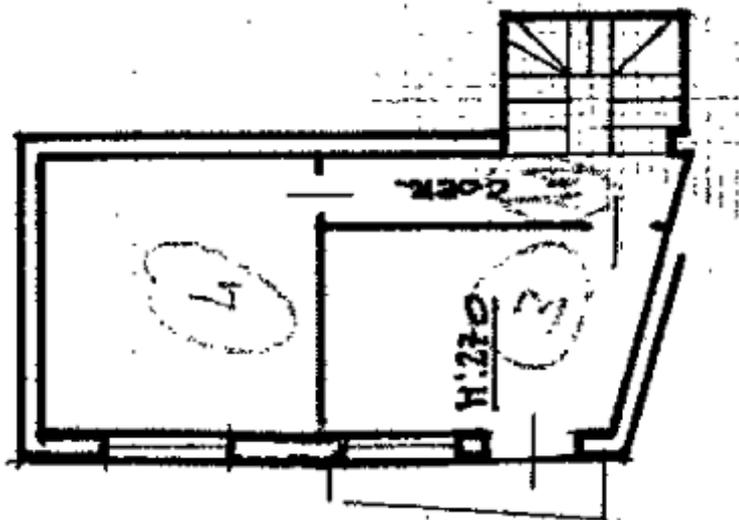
Planimetria catastali dei beni, sub. 1 (p.2).
